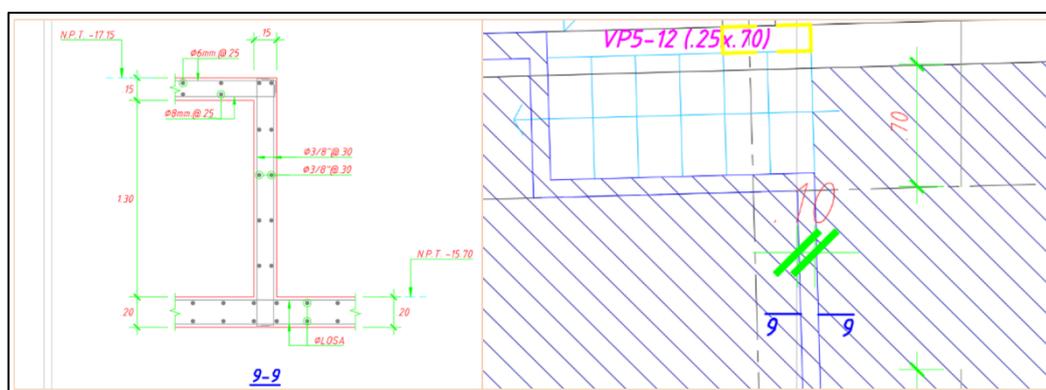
Vista en corte y en planta del muro ubicado en el 5to piso
